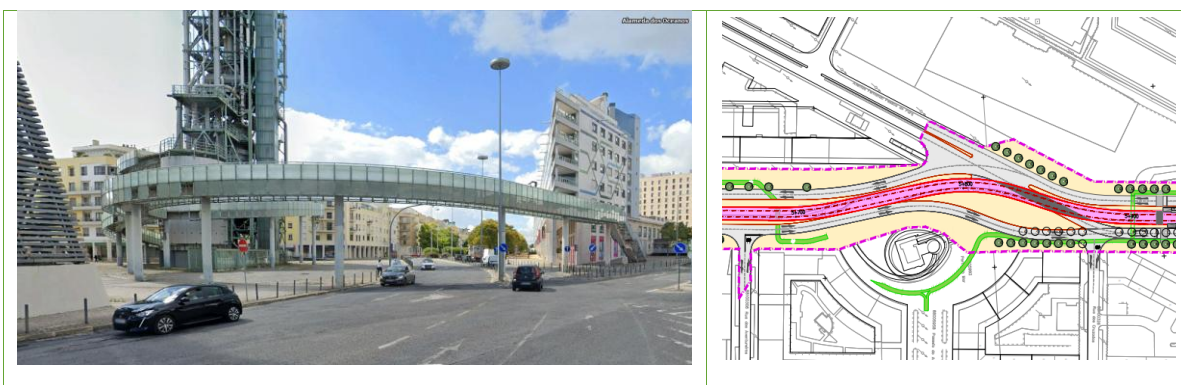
Passadiço da Torre da Refinaria e Porta do Mar - Traçado em planta
